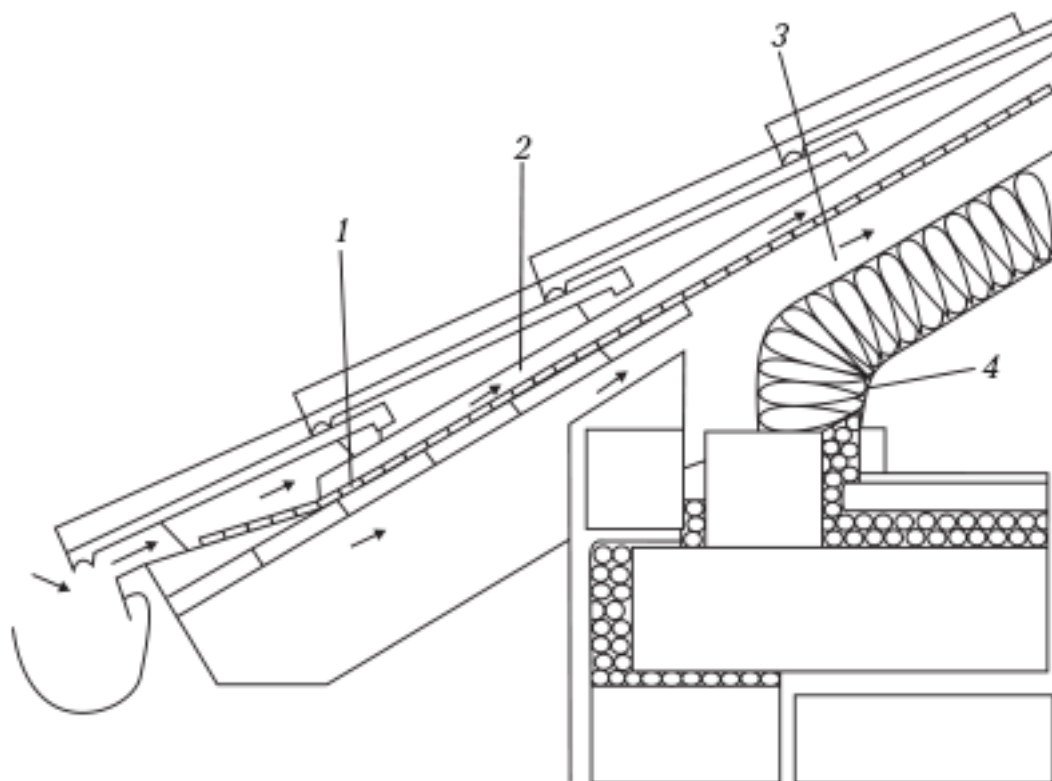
Общая схема утепленной крыши: 1 – подкровельная гидроизоляция; 2 – контро-брушечка; 3 – теплоизоляция; 4 – паронепроницаемый слой
